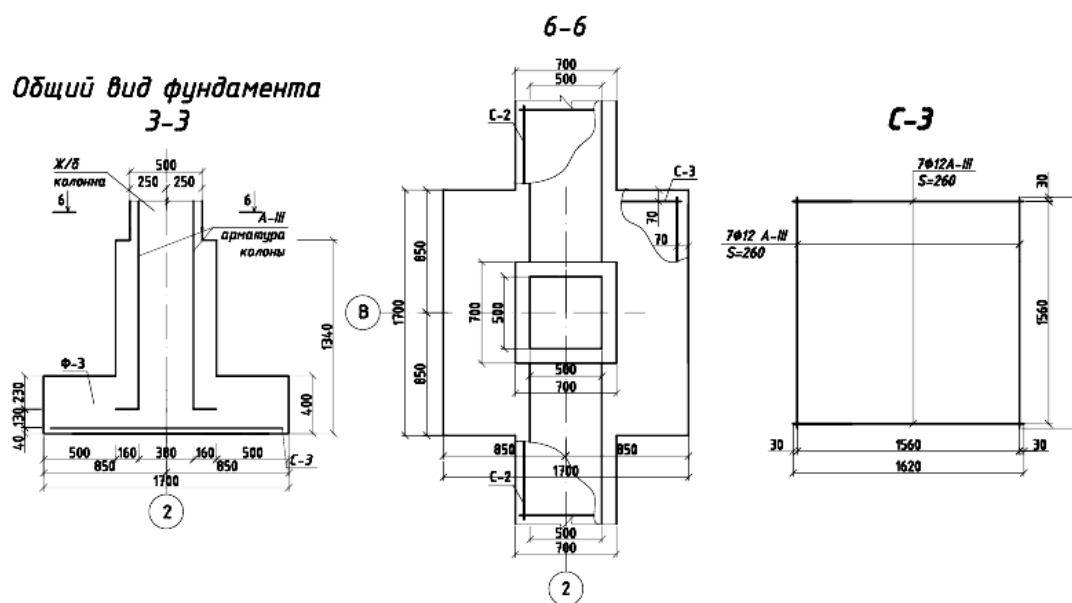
Конструкция фундамента колонны сечением 500x500
